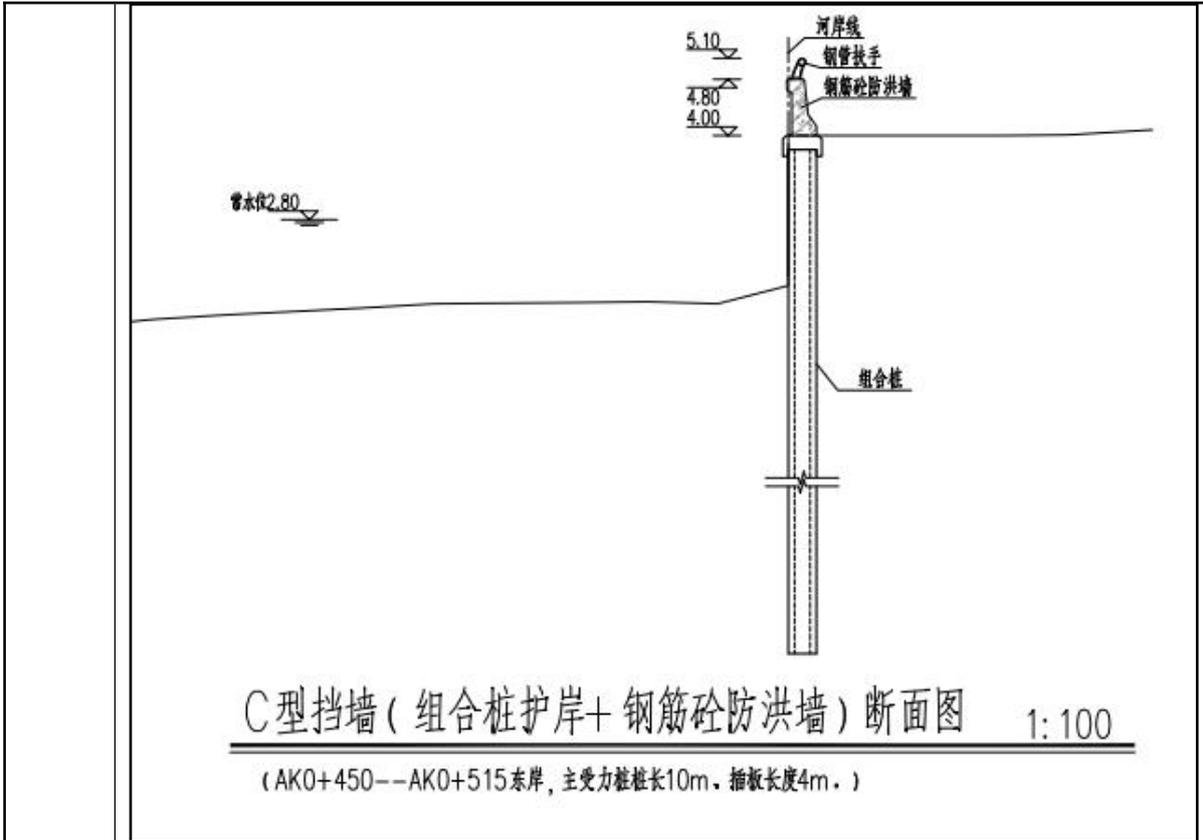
C型挡墙(组合桩护岸+钢筋砼防洪墙)断面图
